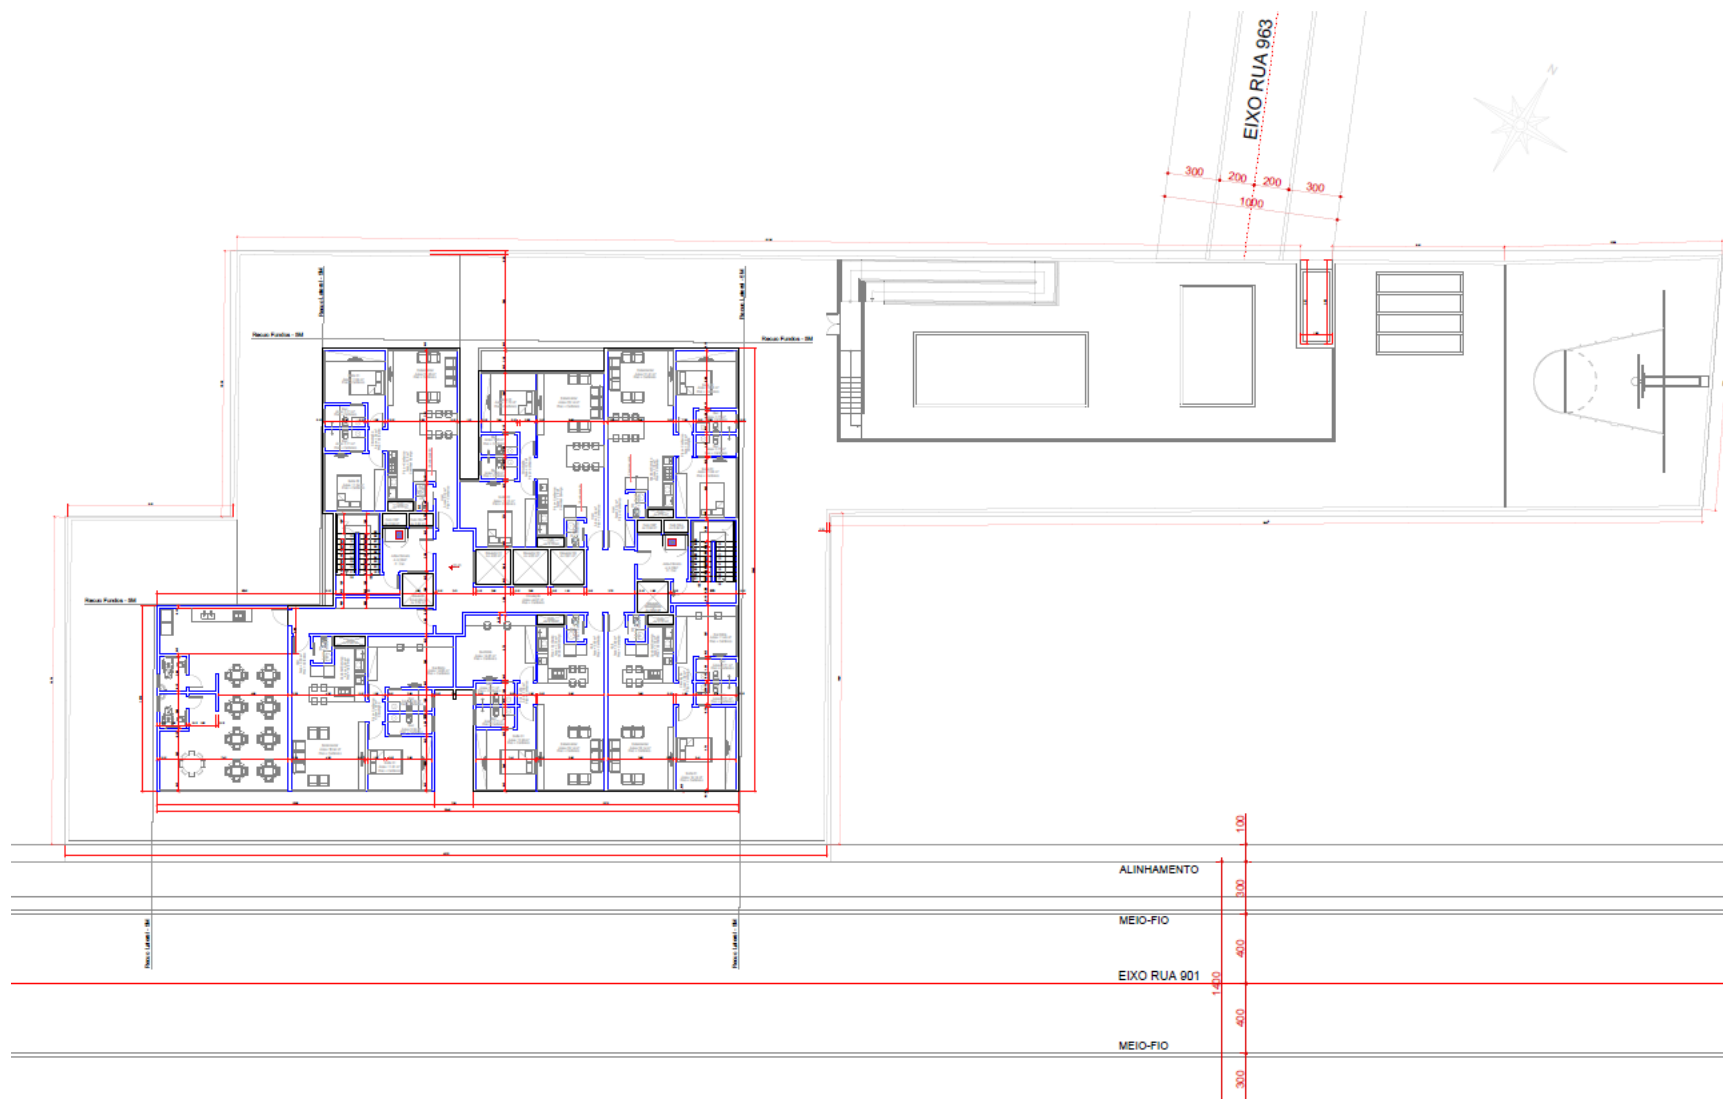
Planta Baixa - Pavimento Tipo 02x1 (Cobertura) - Área: 649,29 m².
